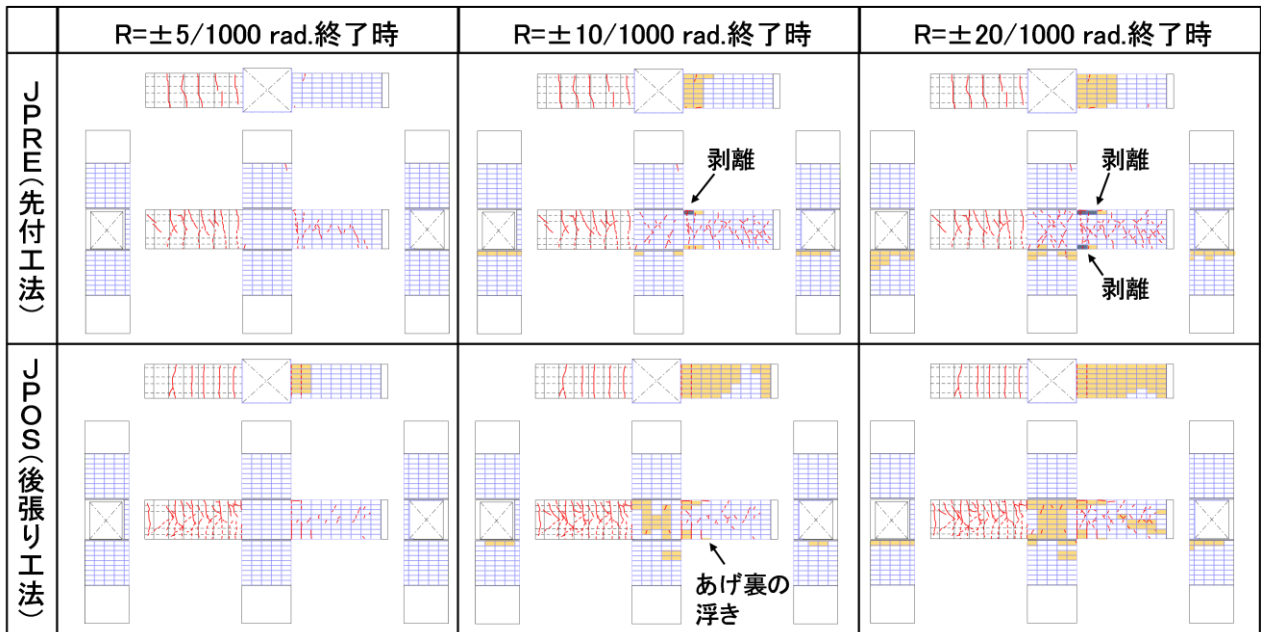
ひび割れおよびタイルの浮き・剥離の発生状況
